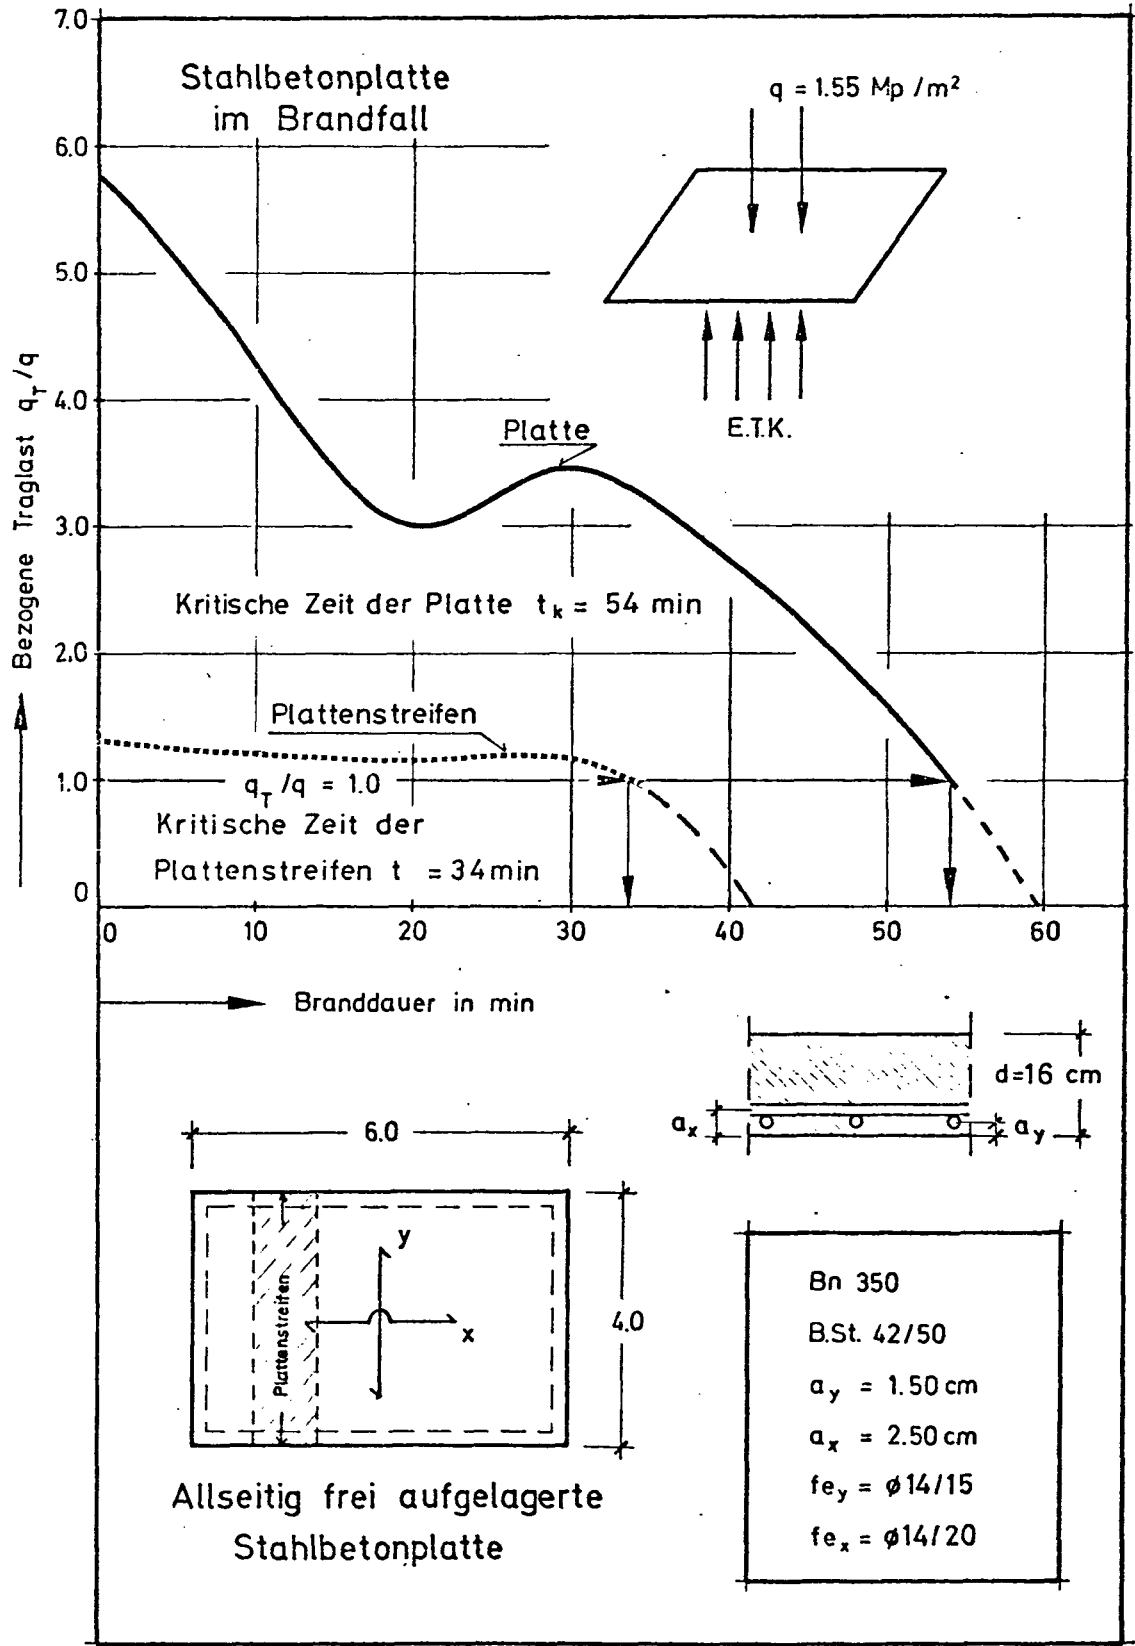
Traglastverlauf einer Stahlbetonplatte im Brandfall
